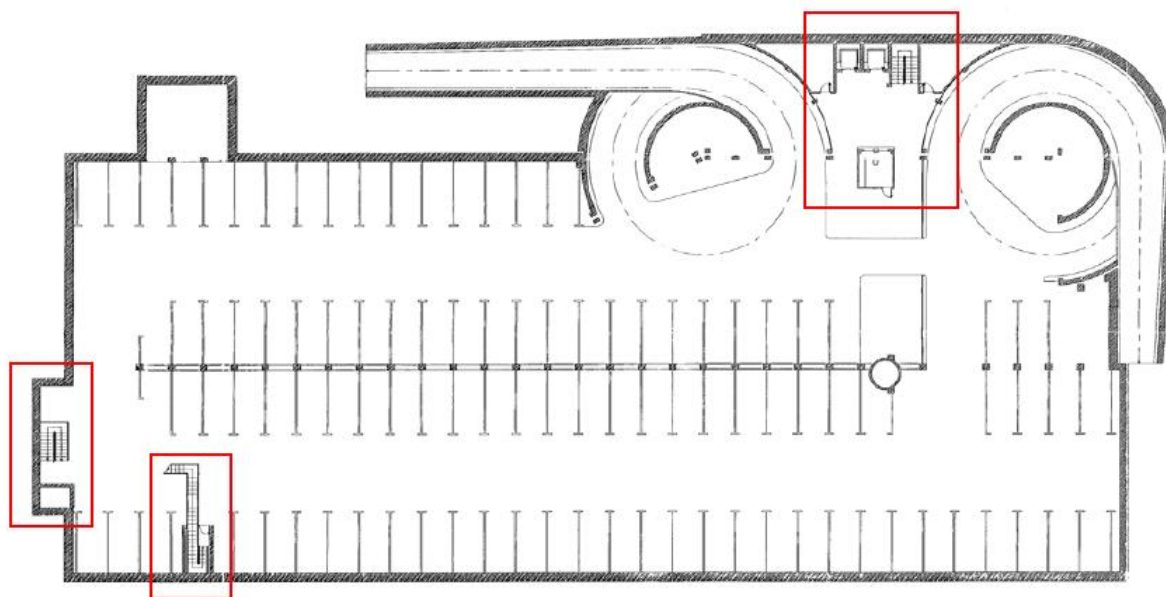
Planta nivel sótano 1- Configuración tras proyecto de 1997
